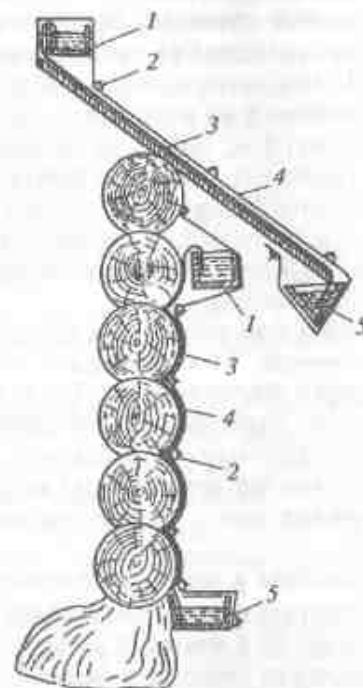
Схема панельной пропитки бревенчатой стены и дощатой кровли: 1 — резервуар с раствором; 2 — элементы крепления панели; 3 — внутренний слой панели; 4 — наружный слой панели; 5 — резервуар-сборник
